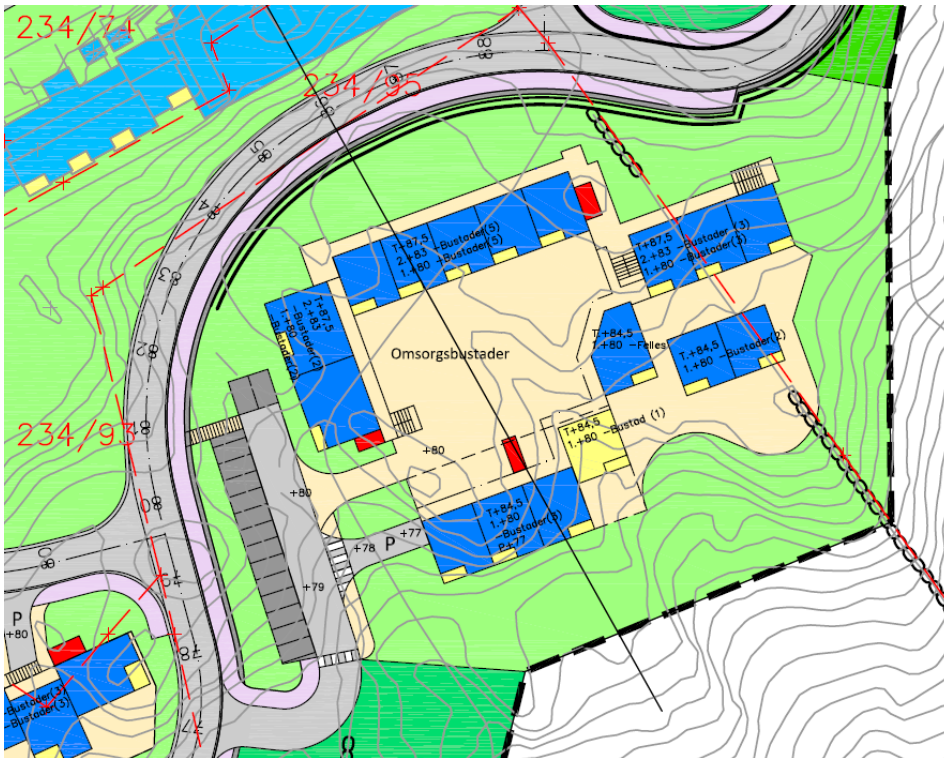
Illustrasjon som viser byggeområde BBB1-BBB4 (ABO Plan & Arkitektur AS)
